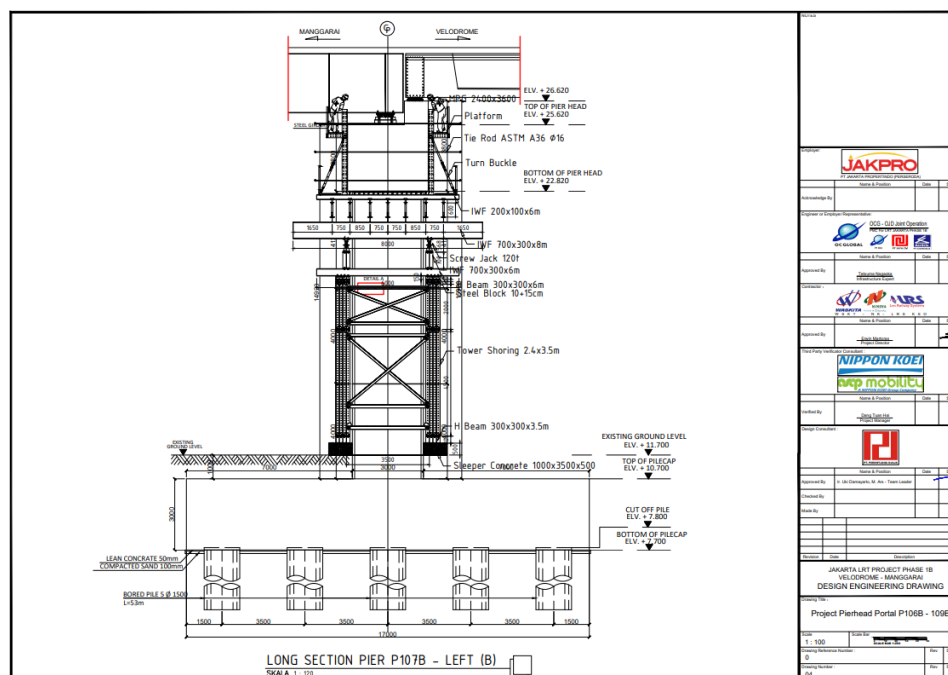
Layout Shoring Pier P107B Tahap 1
